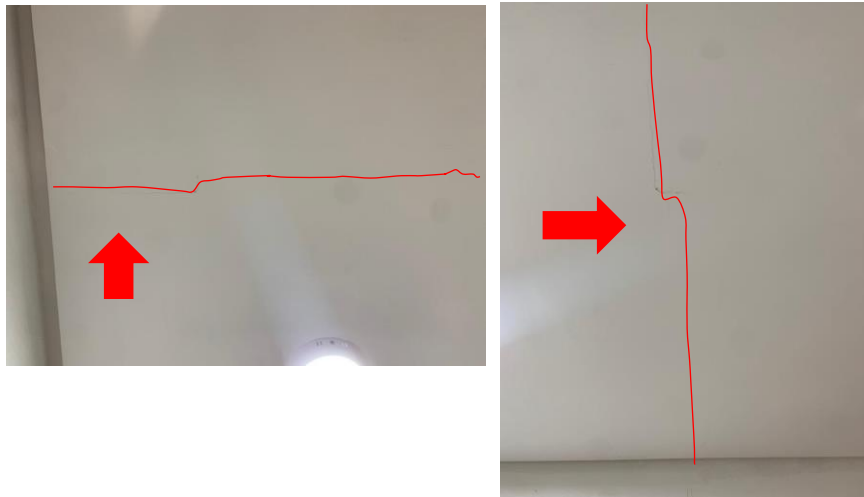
fissuras nas quinas do forro de gesso
